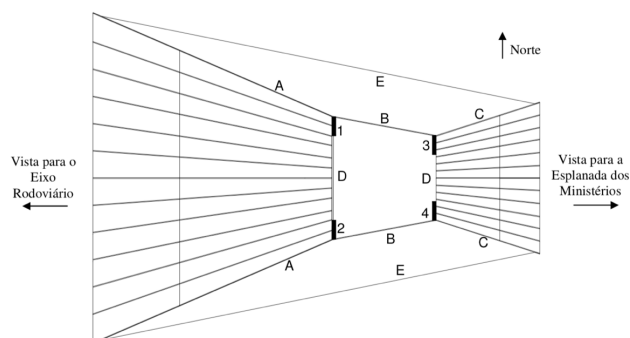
Nomenclatura adotada - sistema estrutural. Fonte: LabRAC.
